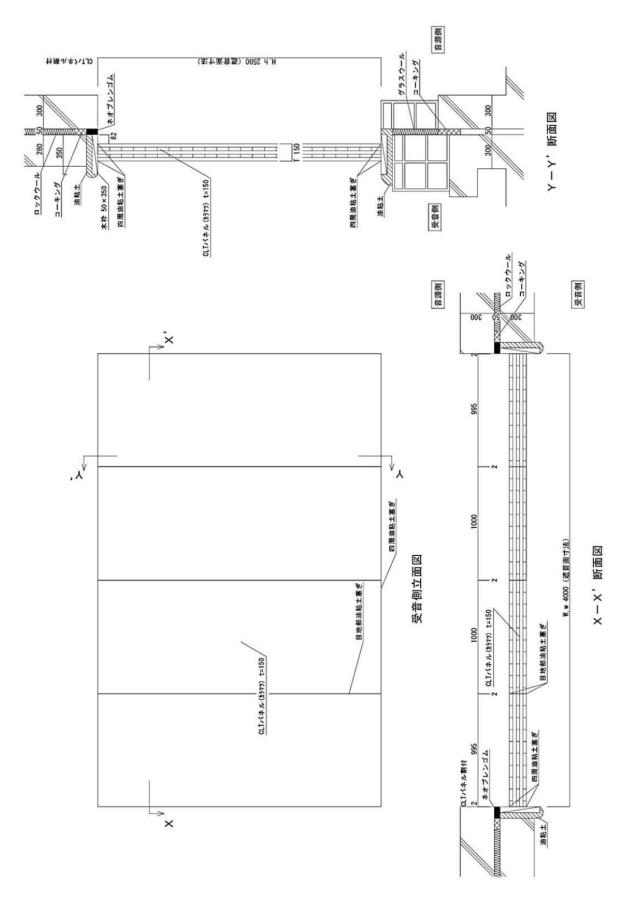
試験体 No.1 の構造・寸法図 寸法単位:mm
